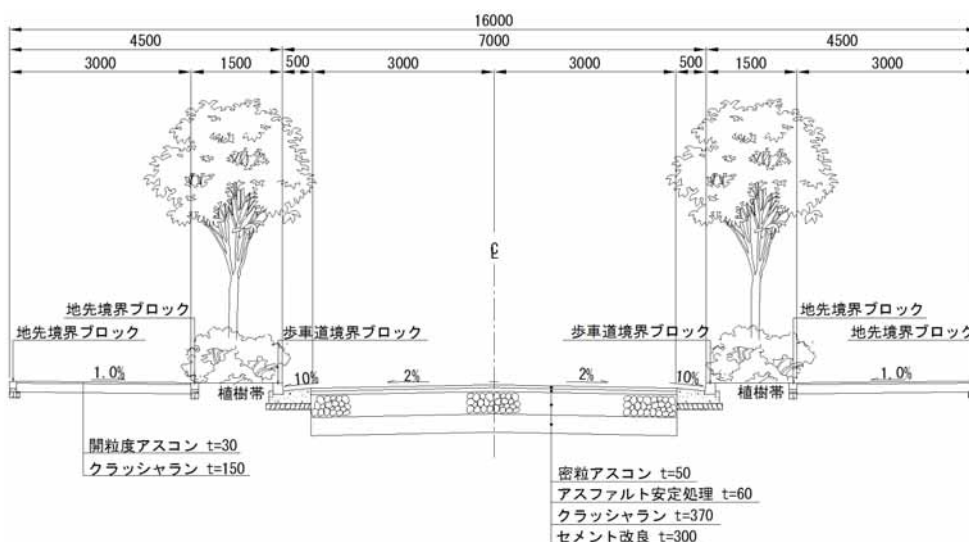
(4) 道路標準断面図（住区内幹線道路）
